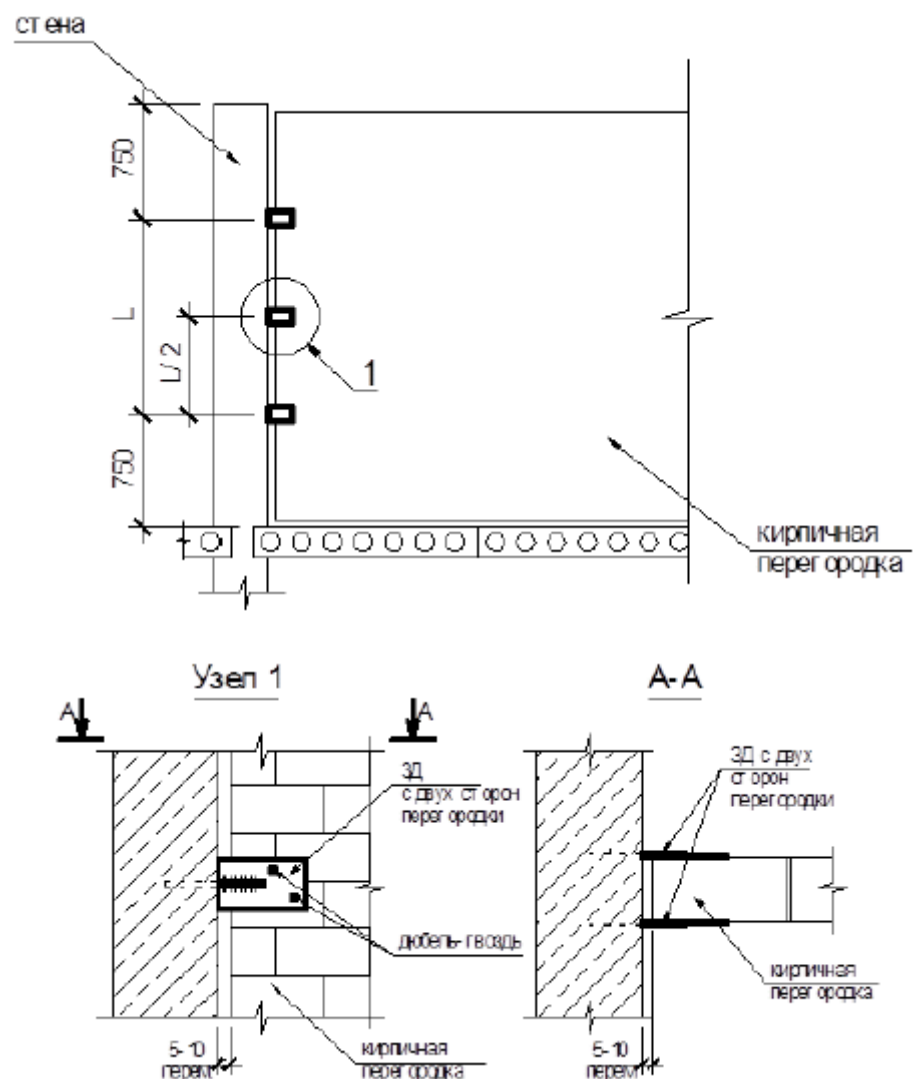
Схема крепления перегородок в местах сопряжения с капитальными стенами закладными деталями
